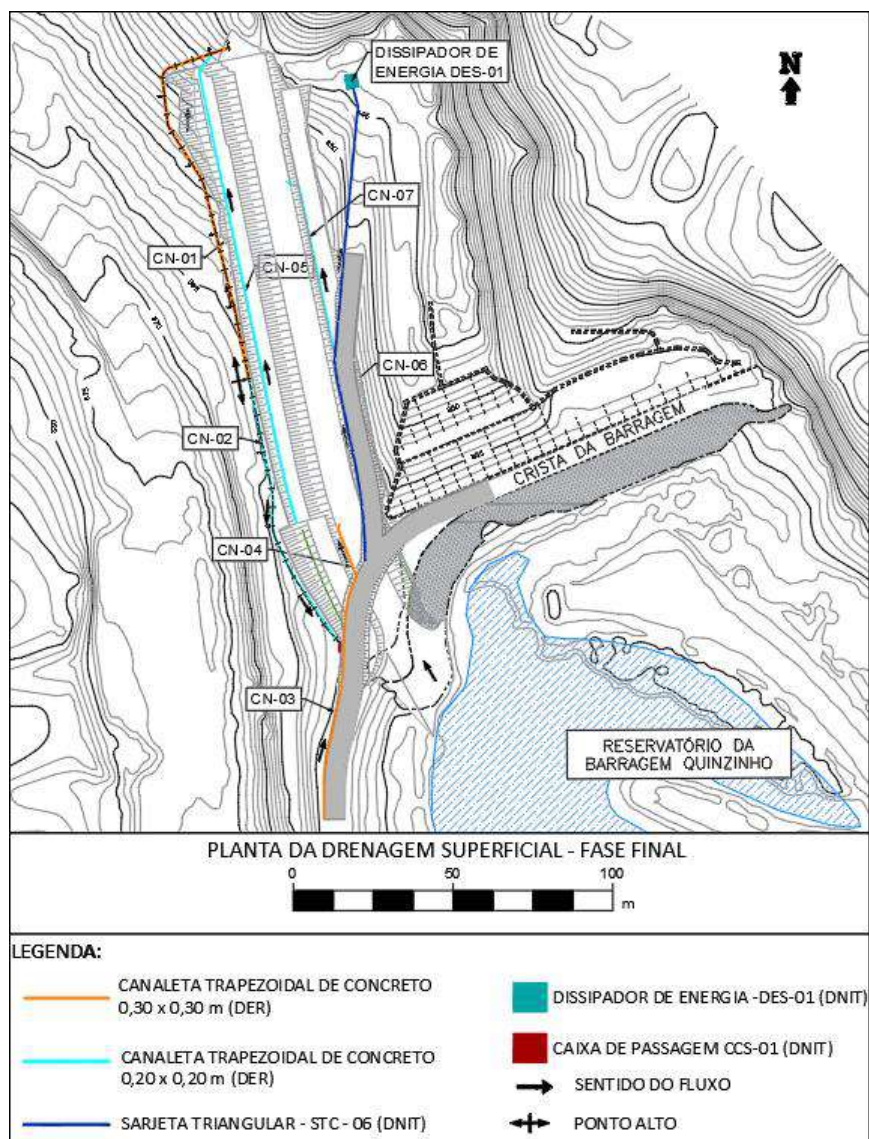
Sistema de Drenagem Superficial – Planta. Fonte: 1850EE-X-83722 (CGF-E-BQ-DE-306)
